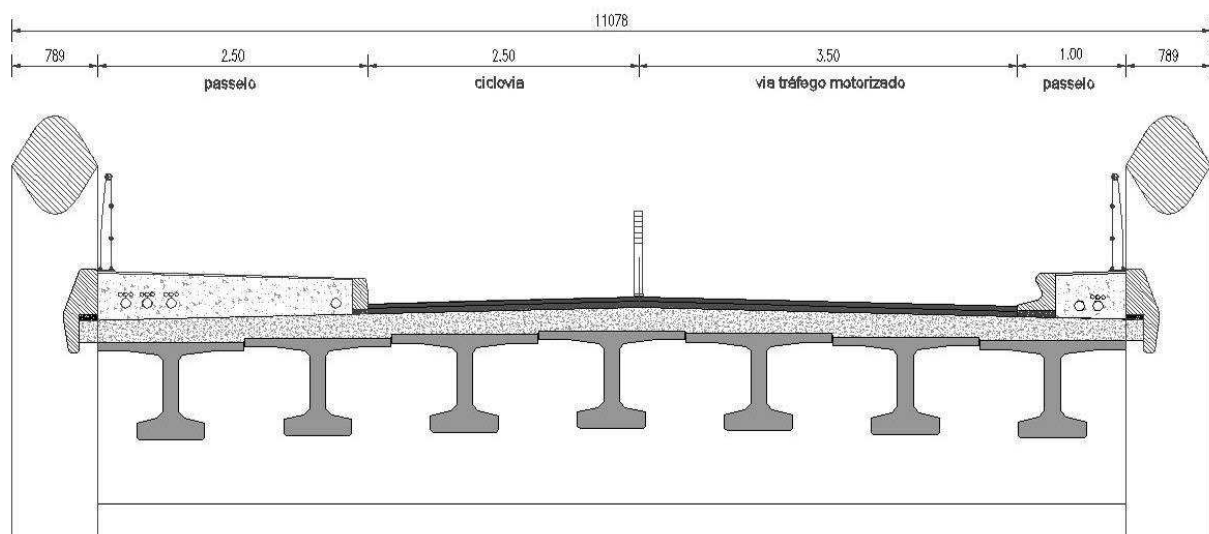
Perfil transversal do tabuleiro da nova ponte (esquemático)
